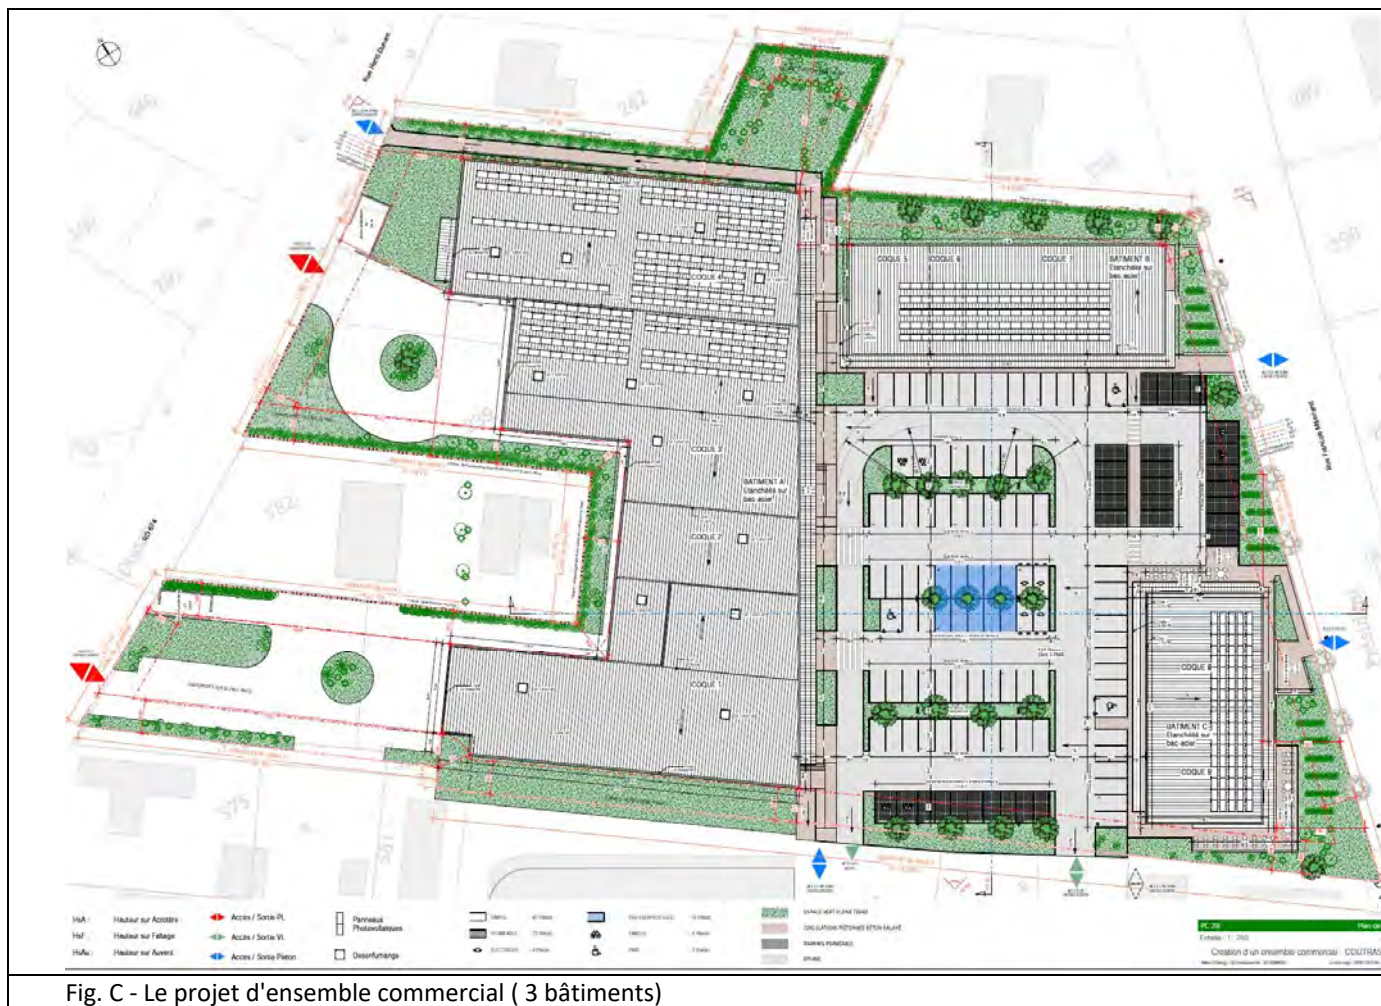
Fig. C - Le projet d'ensemble commercial (3 bâtiments)
